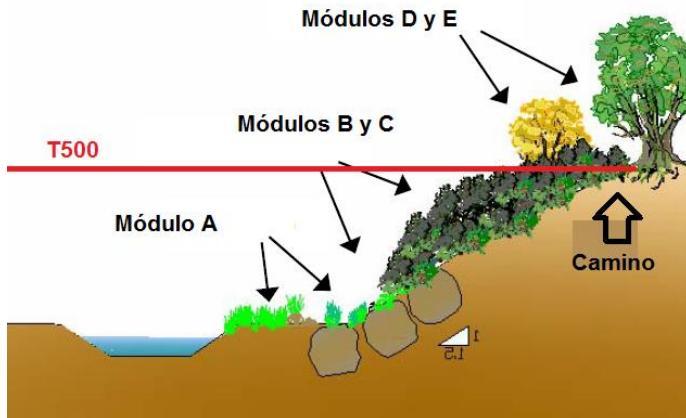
Esquema previsto de la situación de los módulos de plantación.
